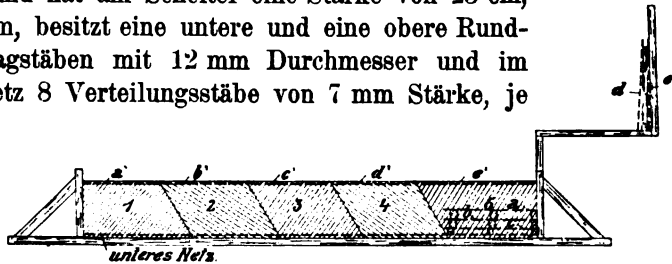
Betonierungsvorgang bei der Waidhofener Brücke.
